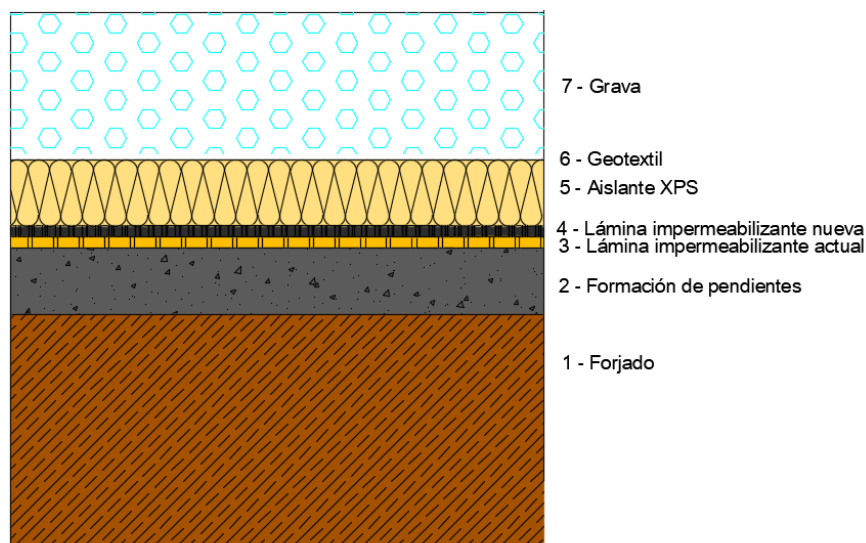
Detalle cubierta plana. Fuente: www.isower.es y modificación propia, creación 08/07/2019
